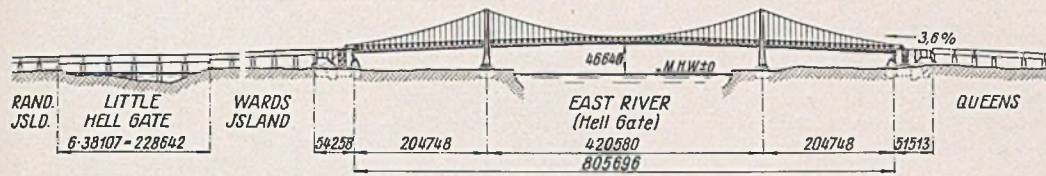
Übersicht der East River-Hängebrücke mit anschließenden Rampenbrücken.
